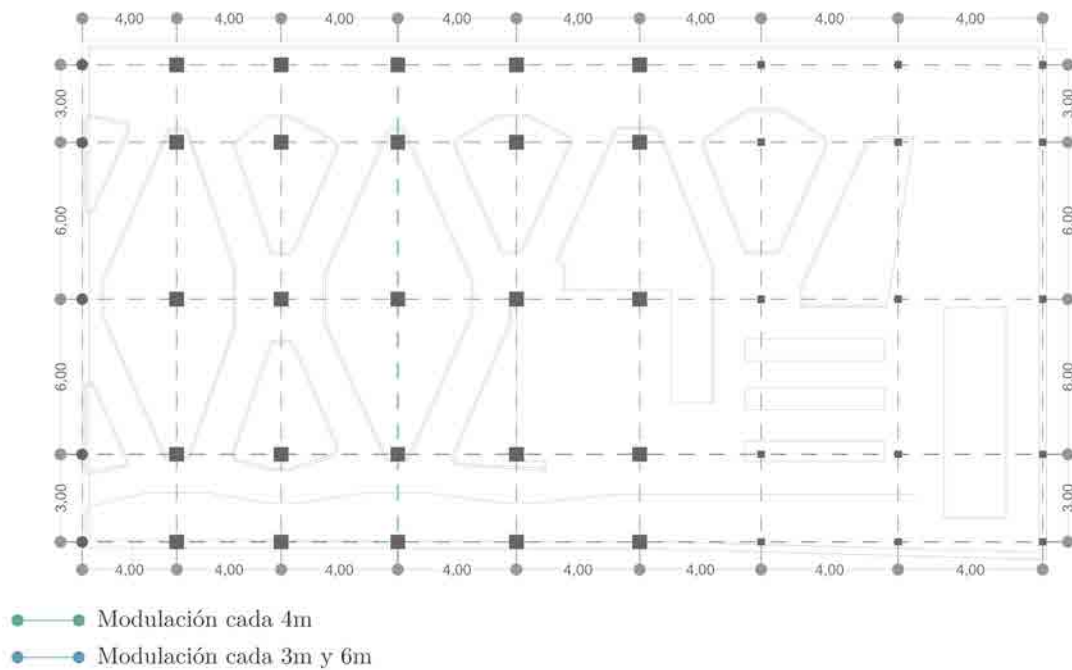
Módulo estructural Mercado Roma. Elaborado: Autores.
